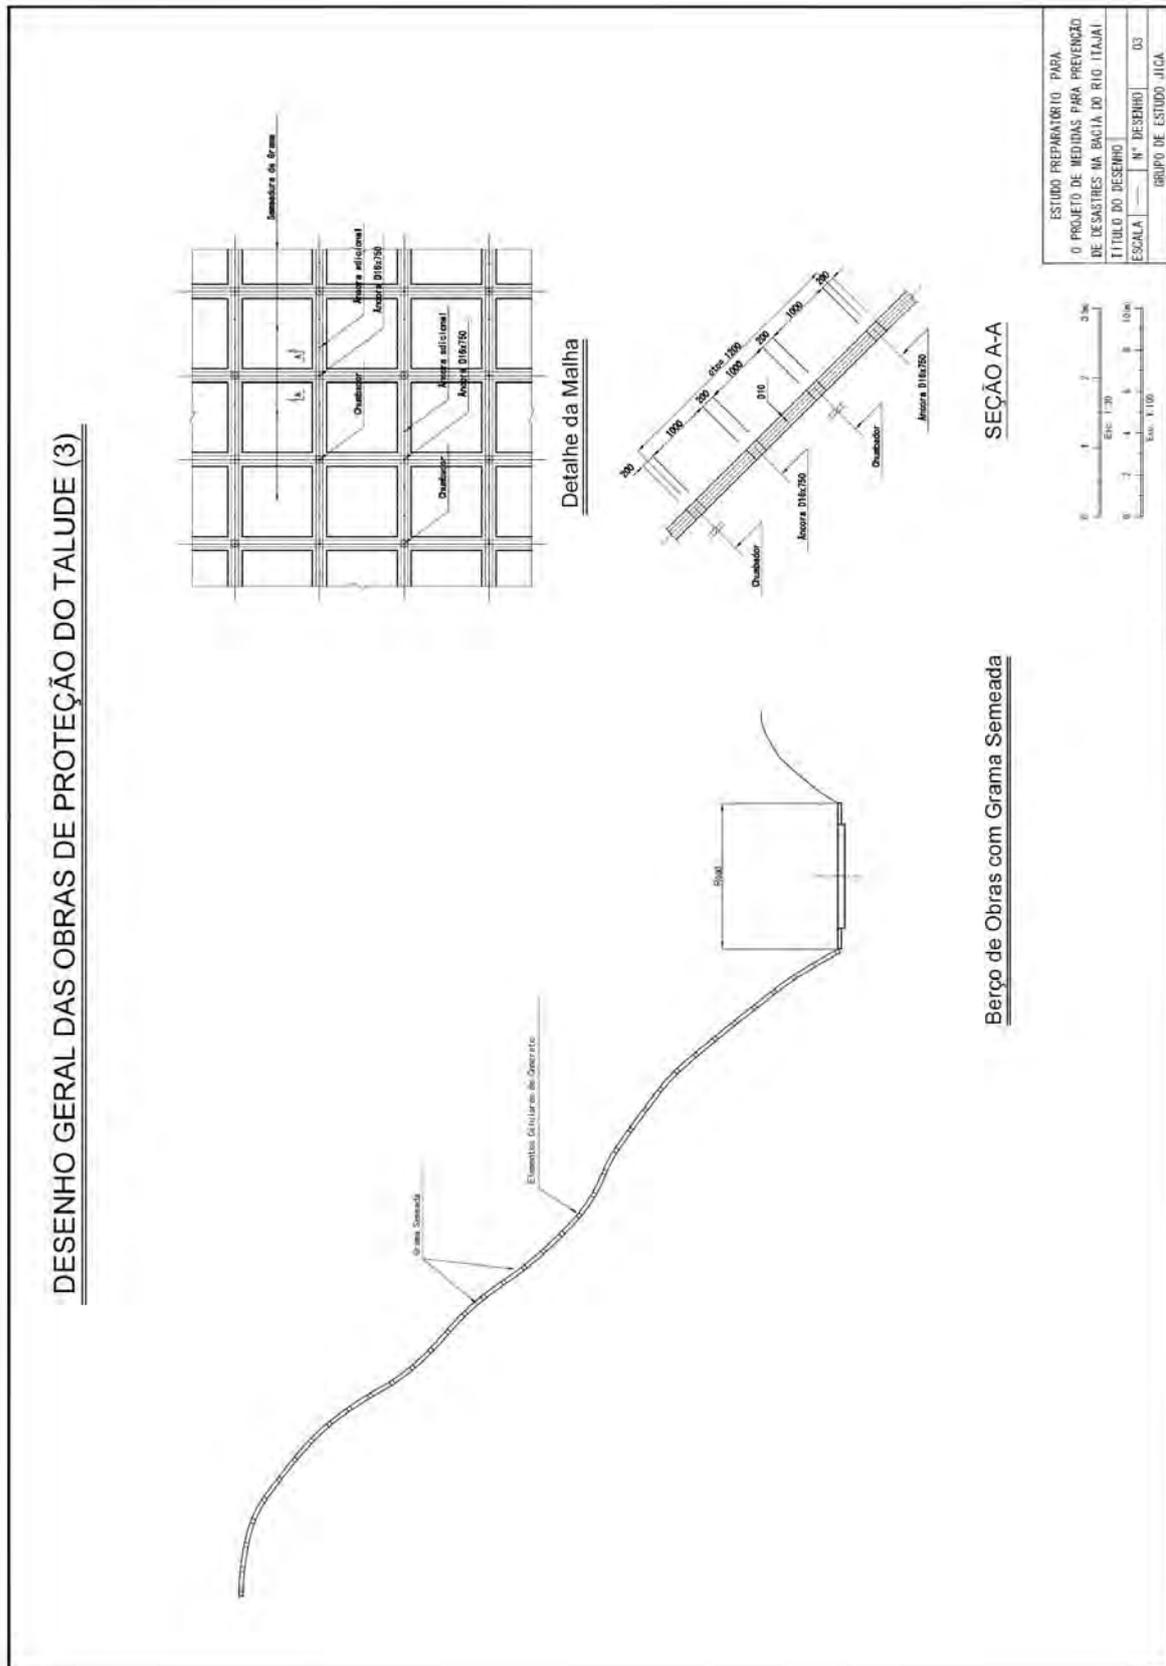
Projeto estrutural da obra de estabilização do talude
